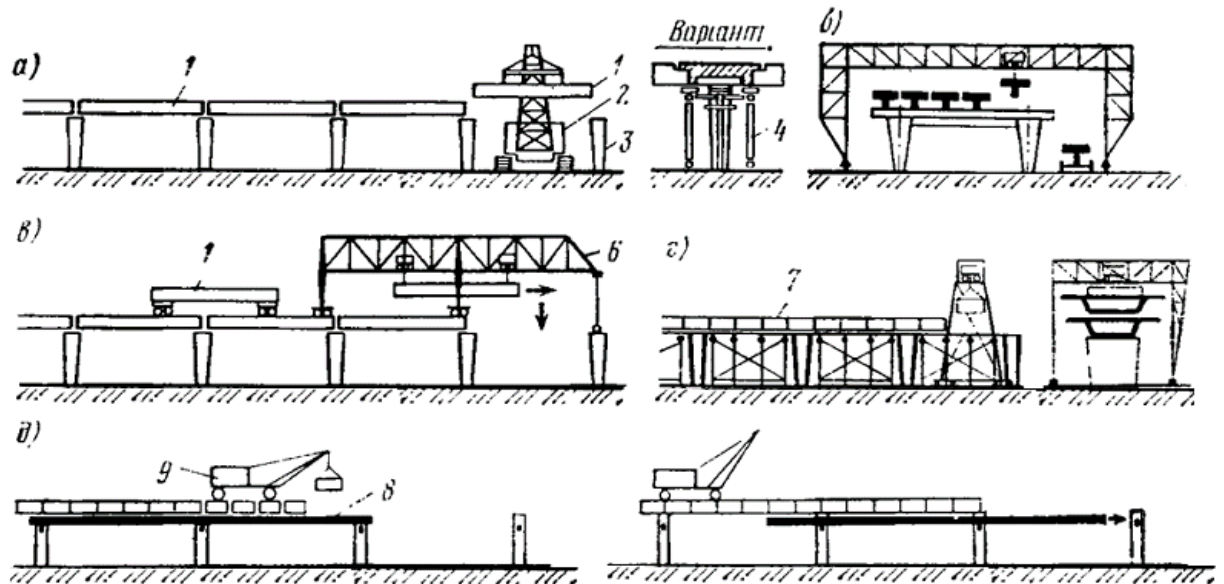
Схеми монтажу прогонових будов з цільнопрогонових балок та блоків на підмостях: 1 – балка прогонової будови; 2 - стріловий кран; 3 - капітальна опора; 4 - тимчасова опора; 5 - порталний кран; 6 - шлюзовий кран; 7 - блок прогонової будови; 8 - рештування, що переміщаються; 9 - монтажний кран
